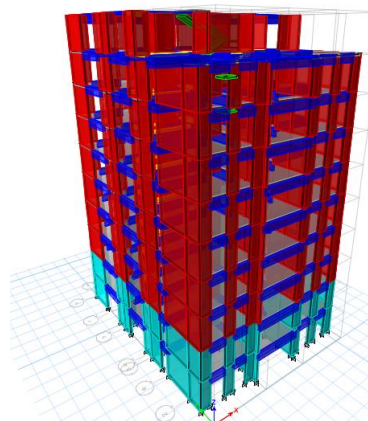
Edificio Amurallado formado por muros y vigas de acople.
